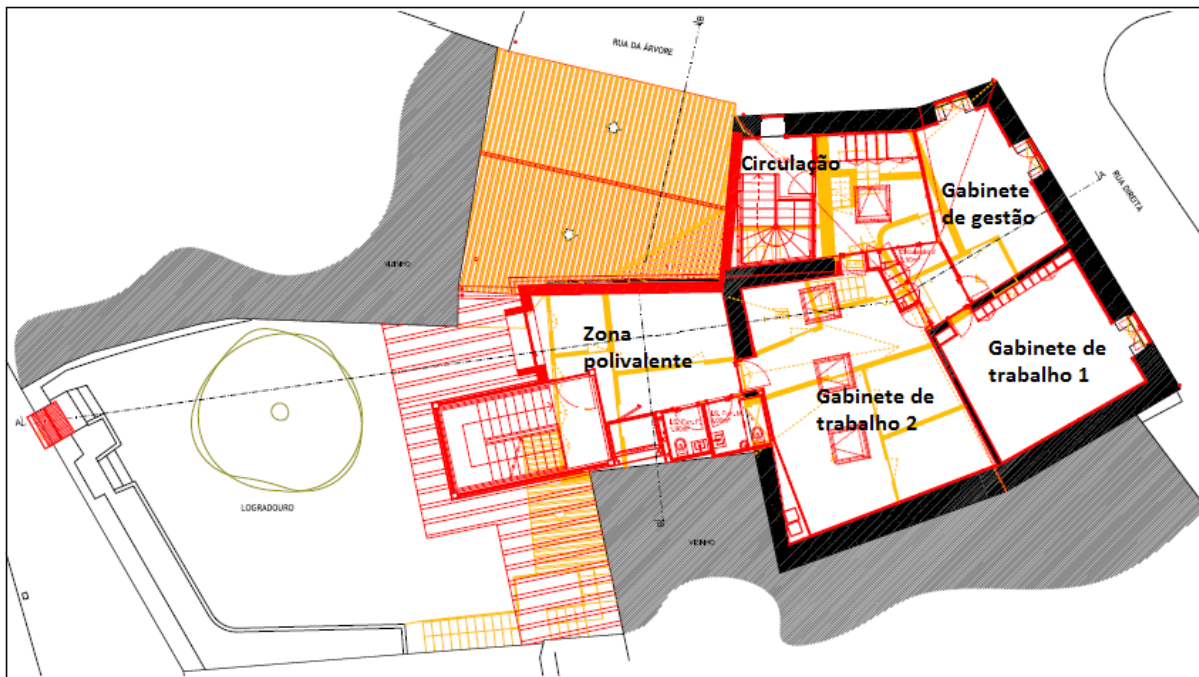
Planta do Piso 2 do edifício 3 em estudo
